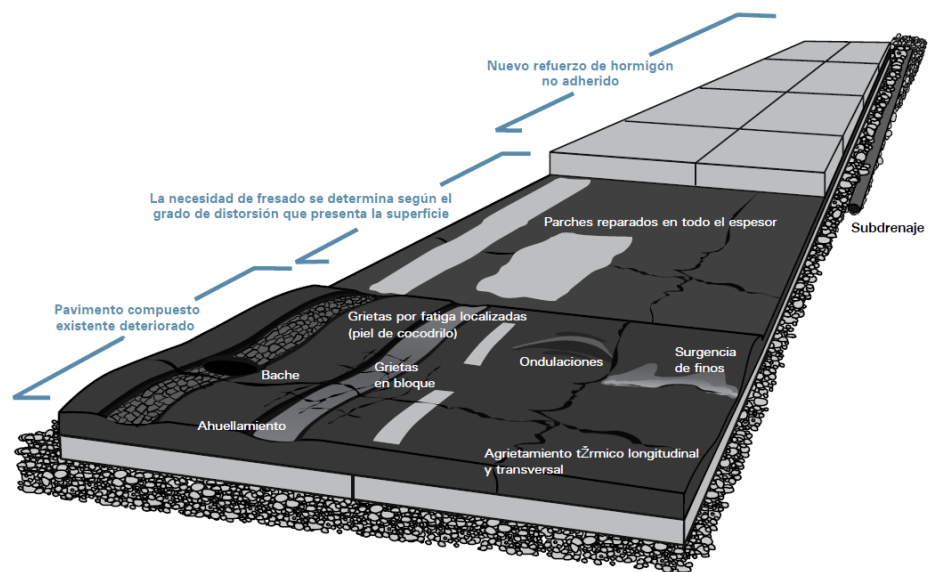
Whitetopping no adherido de un pavimento semirrígido en malas a deterioradas condiciones.
